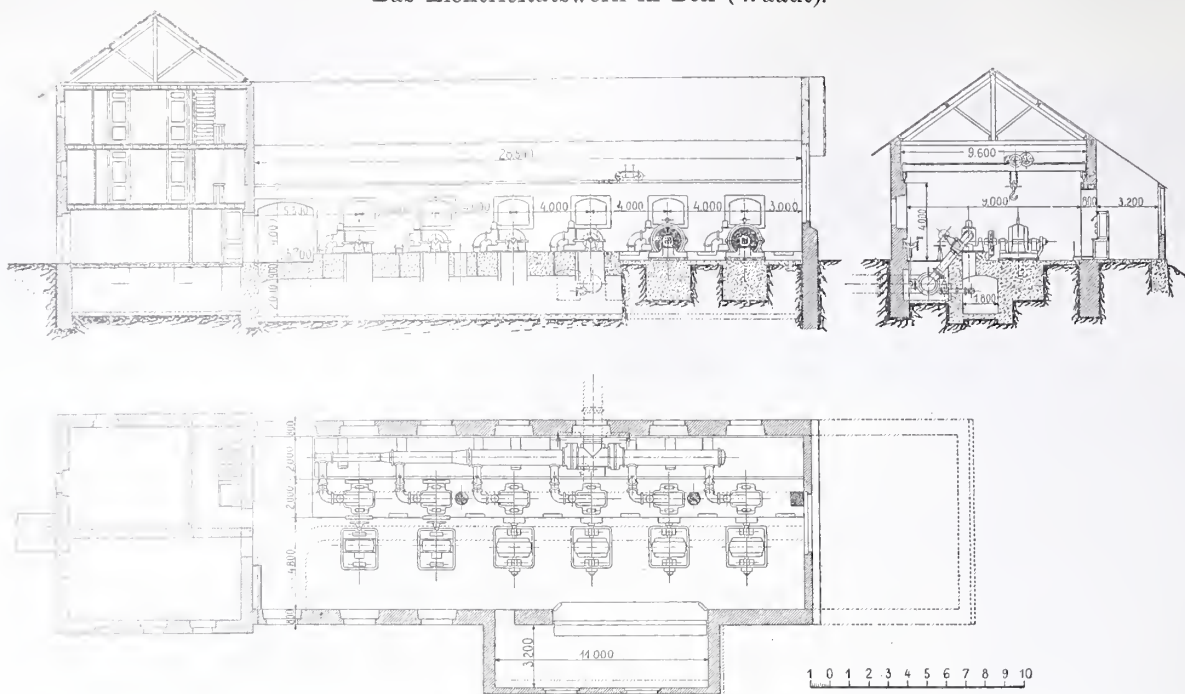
15. Grundriss und Schnitte vom Maschinengebäude. — 1:400.
